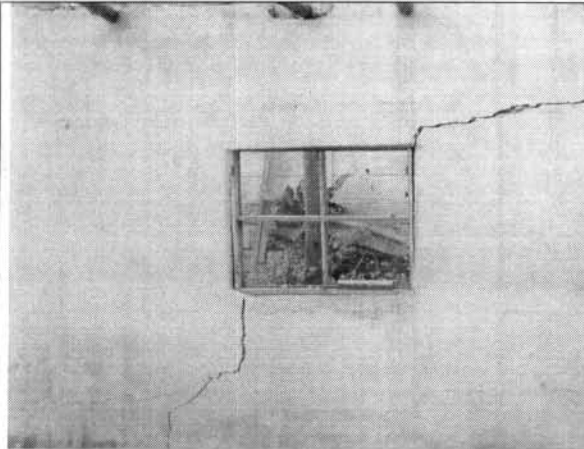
Detalle de las grietas de uno de los muros internos.
